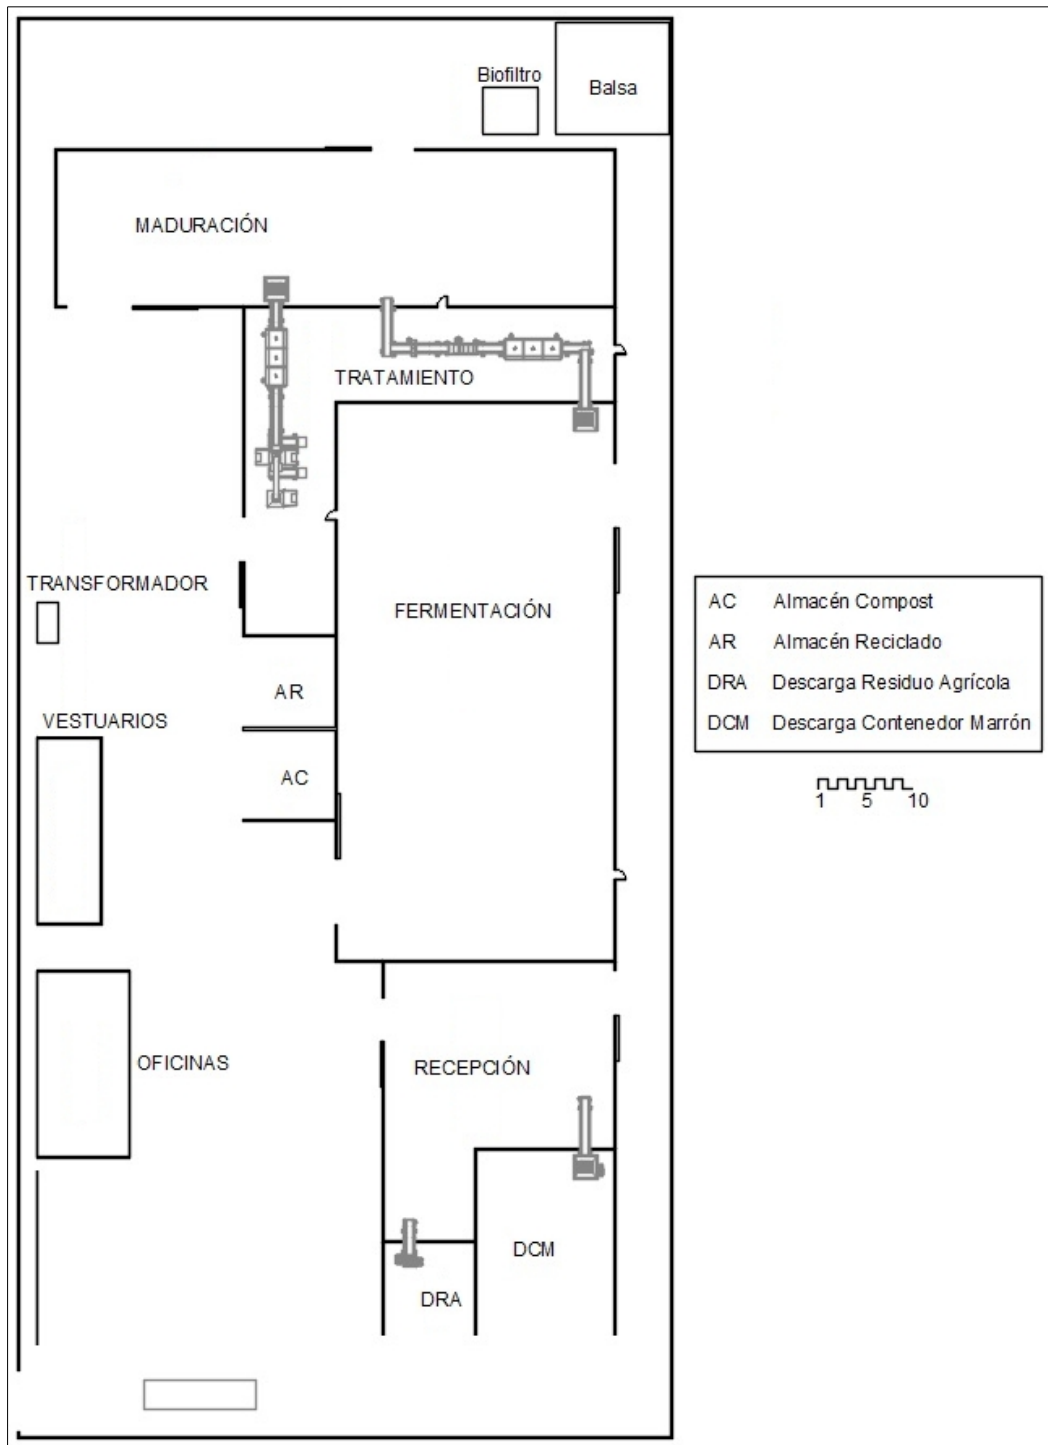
Plano distribución en planta definitiva para el proyecto. Fuente propia.
